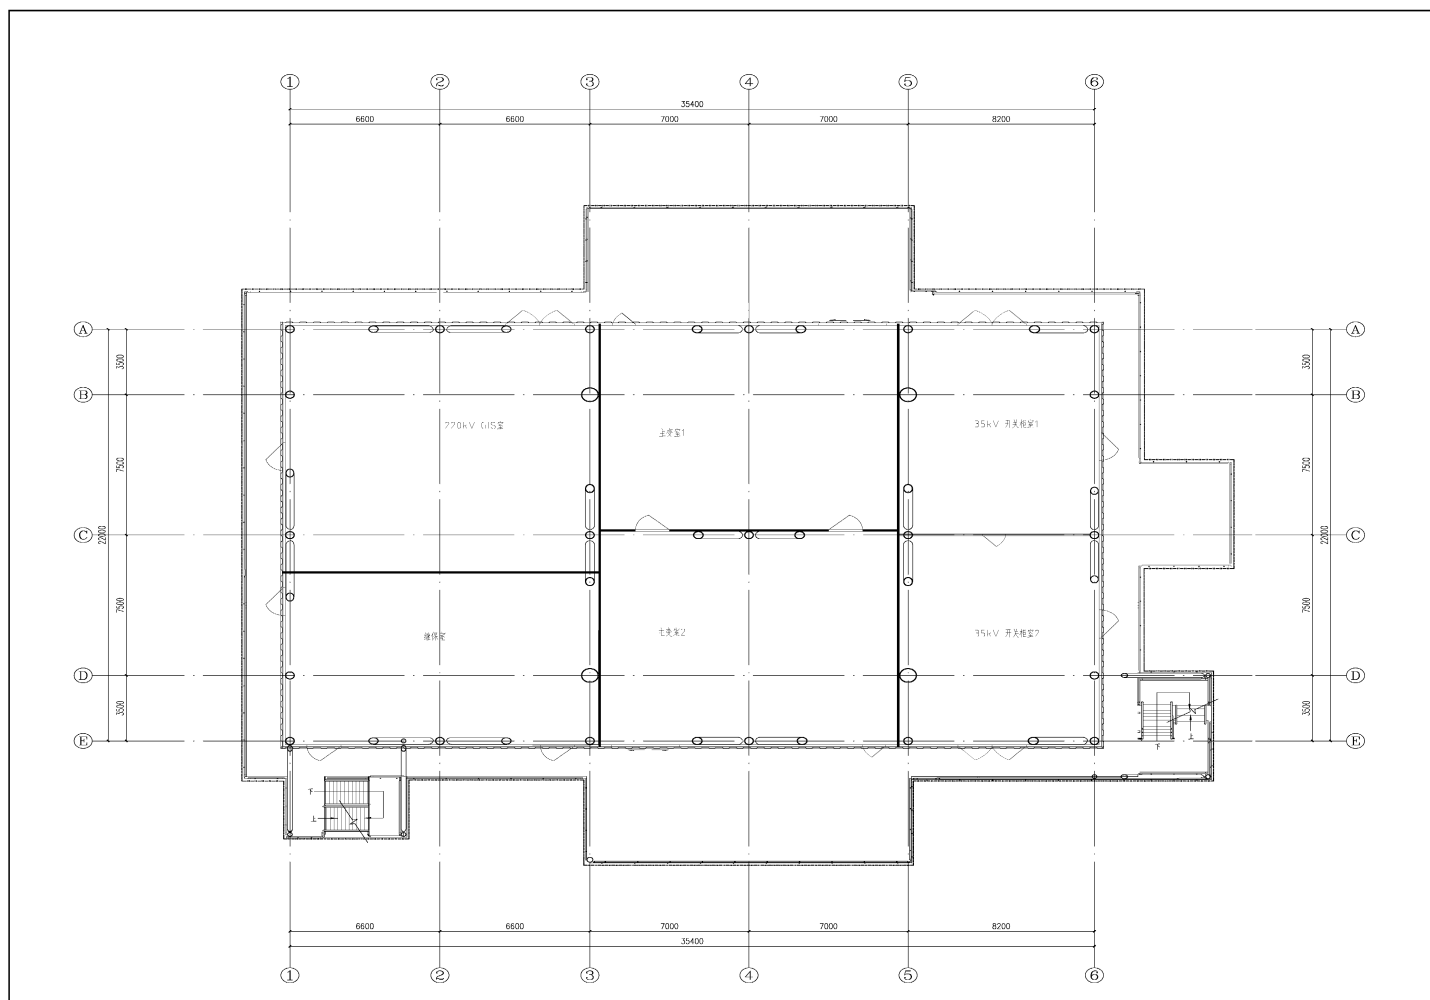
海上升压站（顶层）平面布置示意图（本图由设计单位提供）
